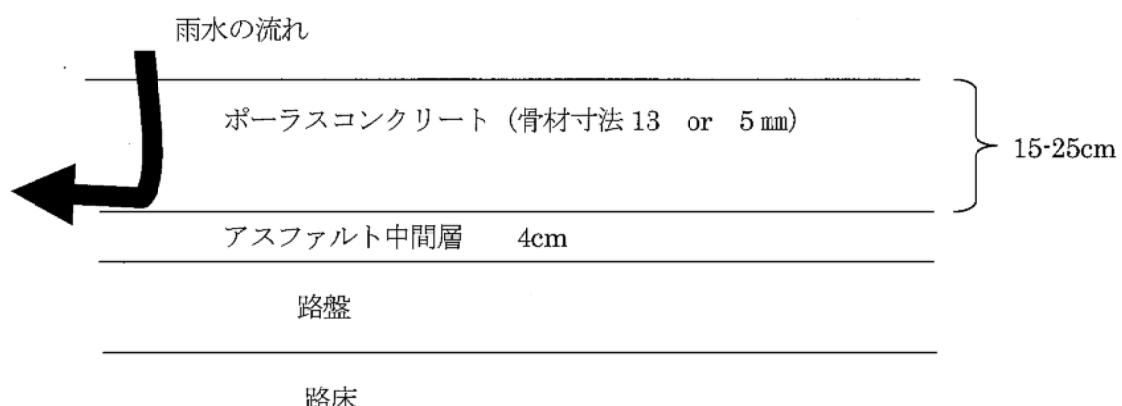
コンクリート版全厚がポーラスコンクリートである構造
